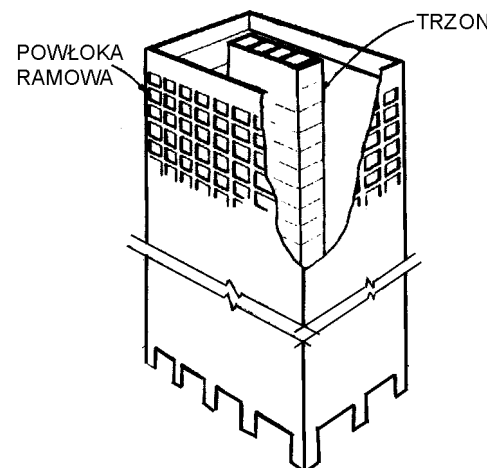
Rozwiązania konstrukcji ramy na kondygnacjach przyziemnych [66]:
